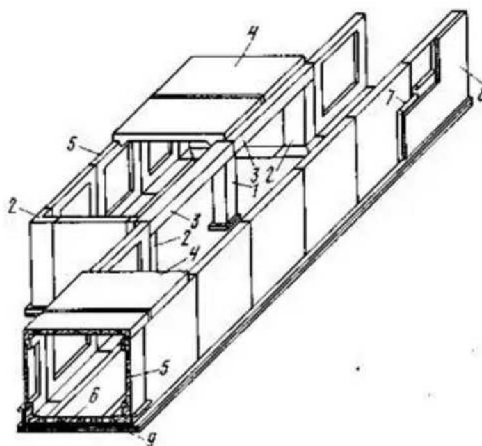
Камера сборного железобетонного коллектора: 1 — колонна; 2 — угловой блок; 3 — балка перекрытия; 4 — плита перекрытия; 5 — стеновой блок; 6 — блок дна; 7 — гидроизоляция; 8 — защитная стенка; 9 — двухслойная подготовка из щебня и бетона [65]
